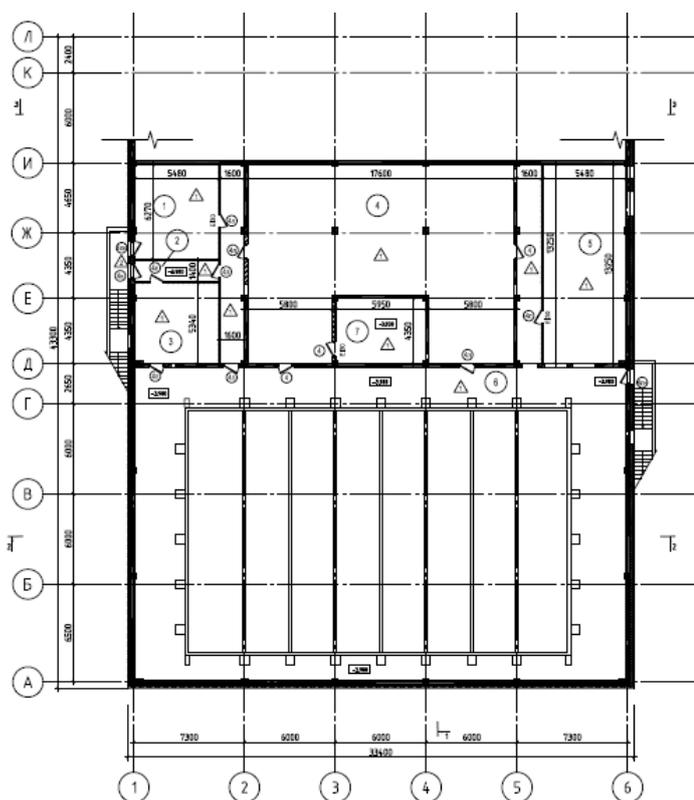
2D план подвального этажа объекта крытого плавательного бассейна САФУ
